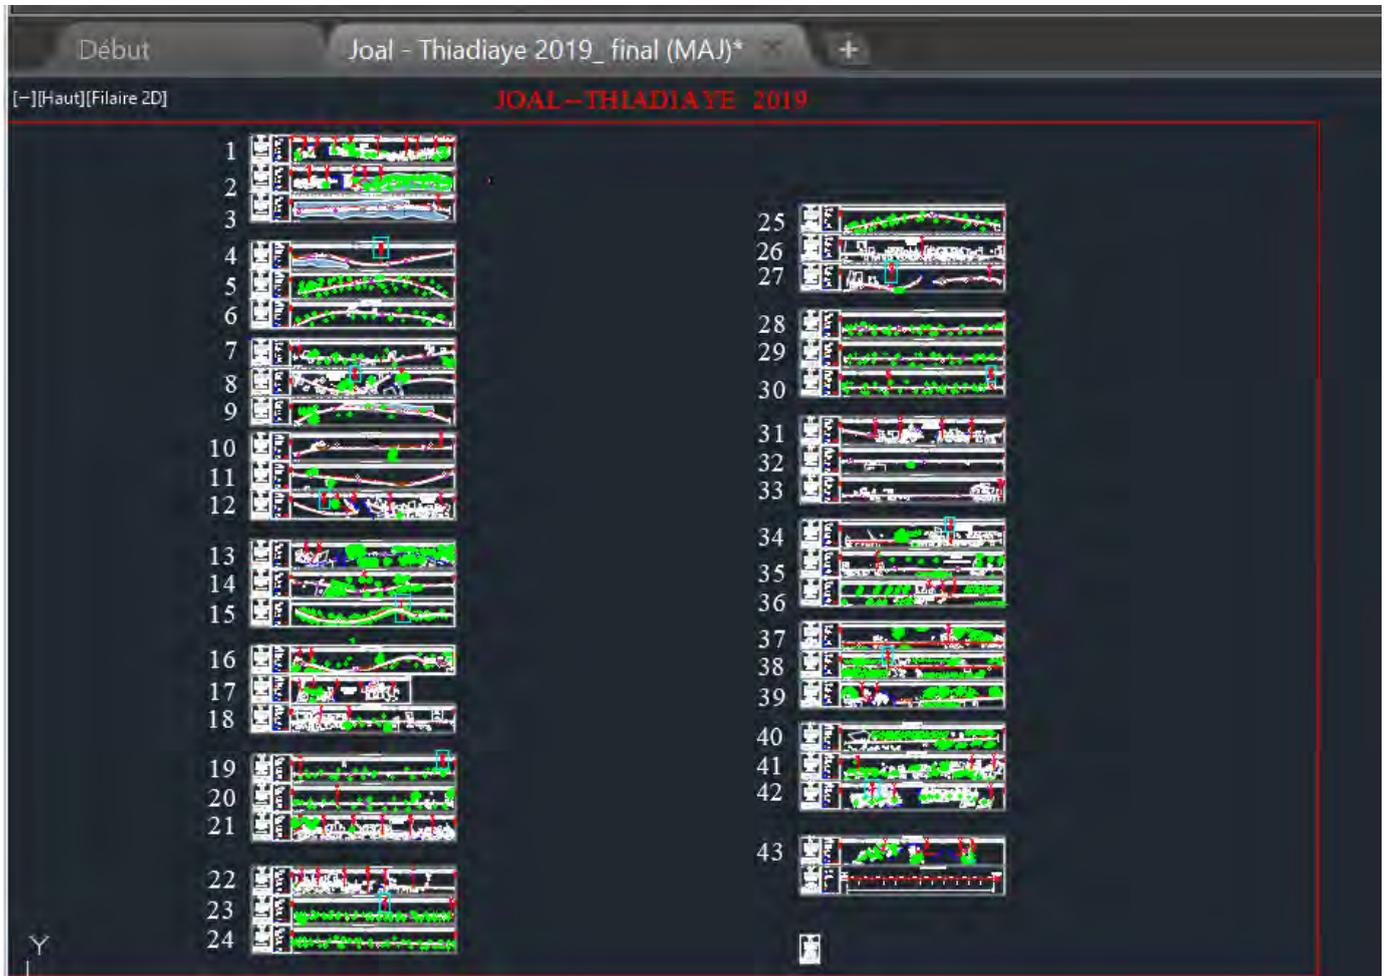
DEMARRAGE DE L'OUTIL AUTOCAD
